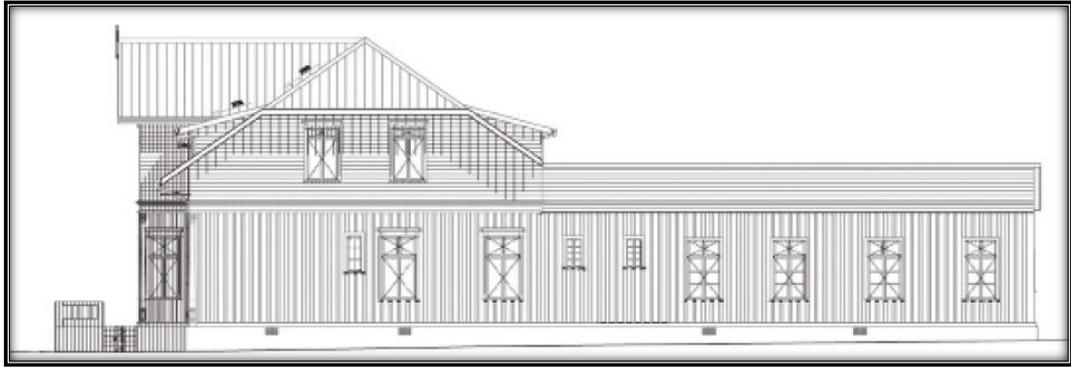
Fachada Frontal y elevación norte de la Casa Prochelle
